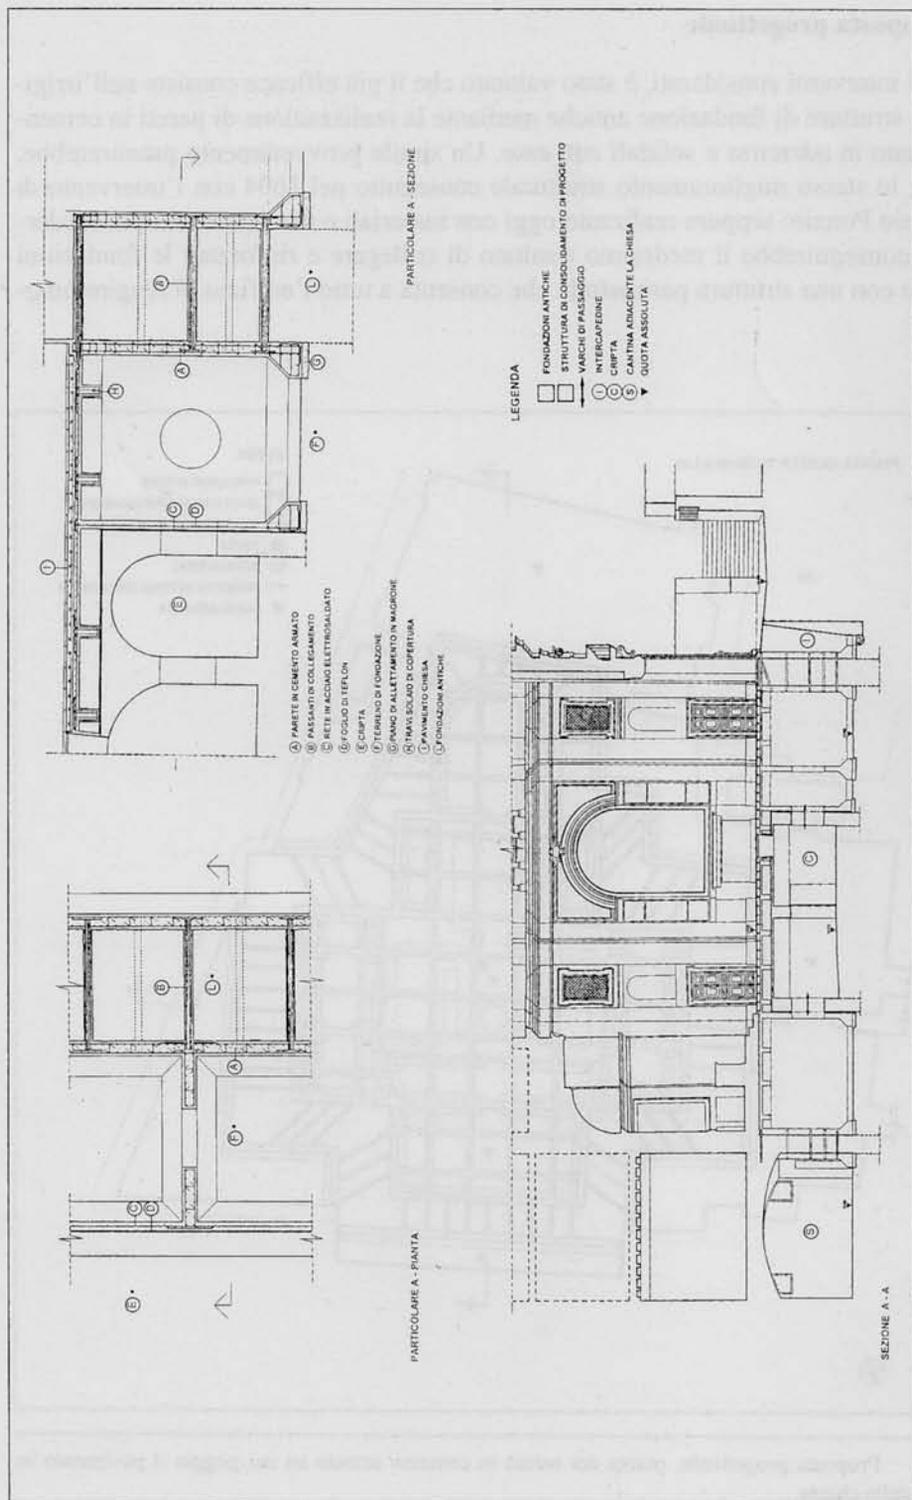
Proposta progettuale: particolari costruttivi della struttura in cemento armato e del suo collegamento alla muratura antica di fondazione.
